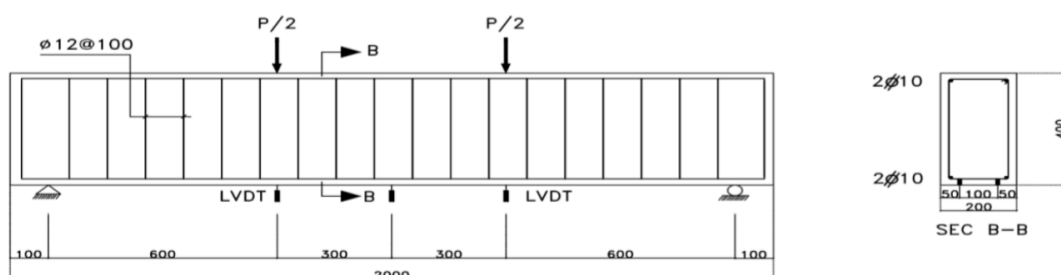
Geometria das vigas (Fonte: Ibrahim *et al*, 2014)
